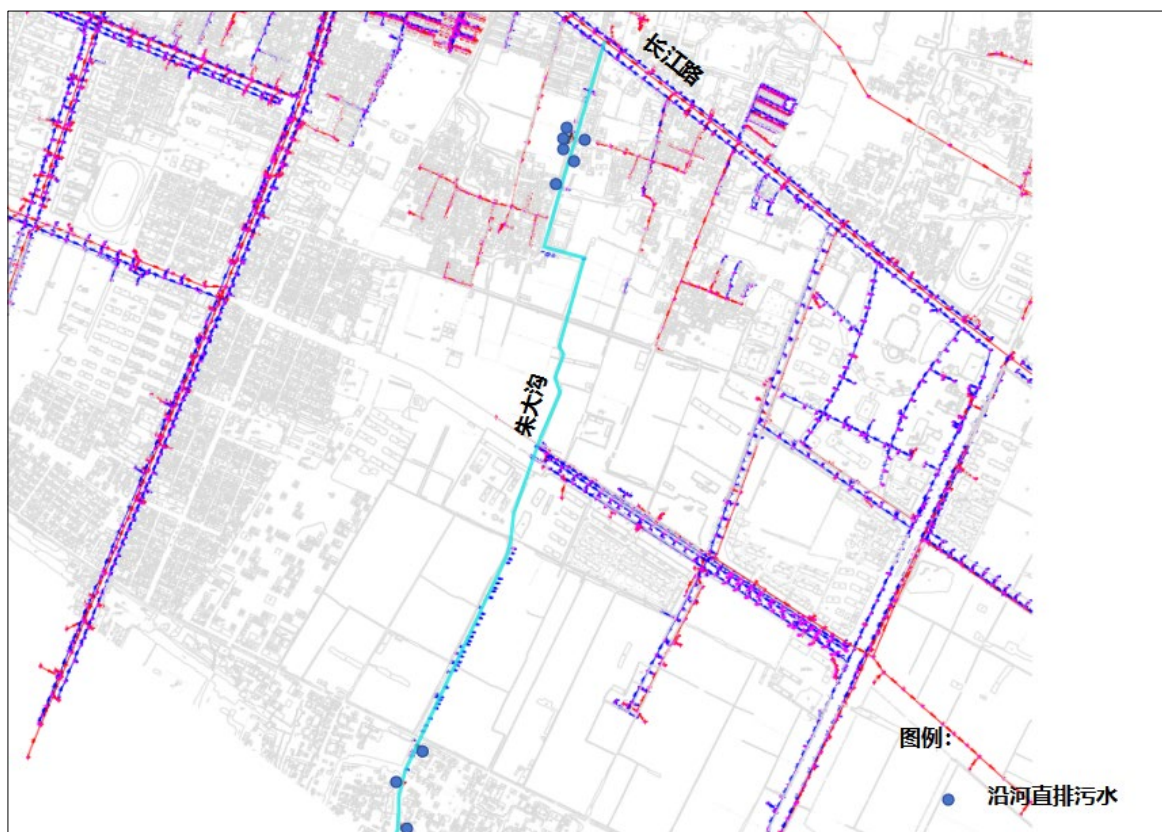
朱大沟沿河散户截污工程平面布置图
